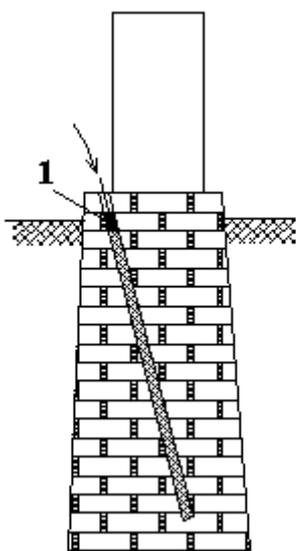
Иньекционное укрепление бутовой кладки фундамента: 1 – пакер
